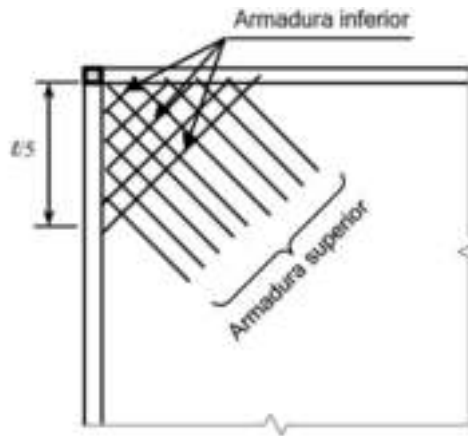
Detalle del armado en esquinas debido a la torsión
